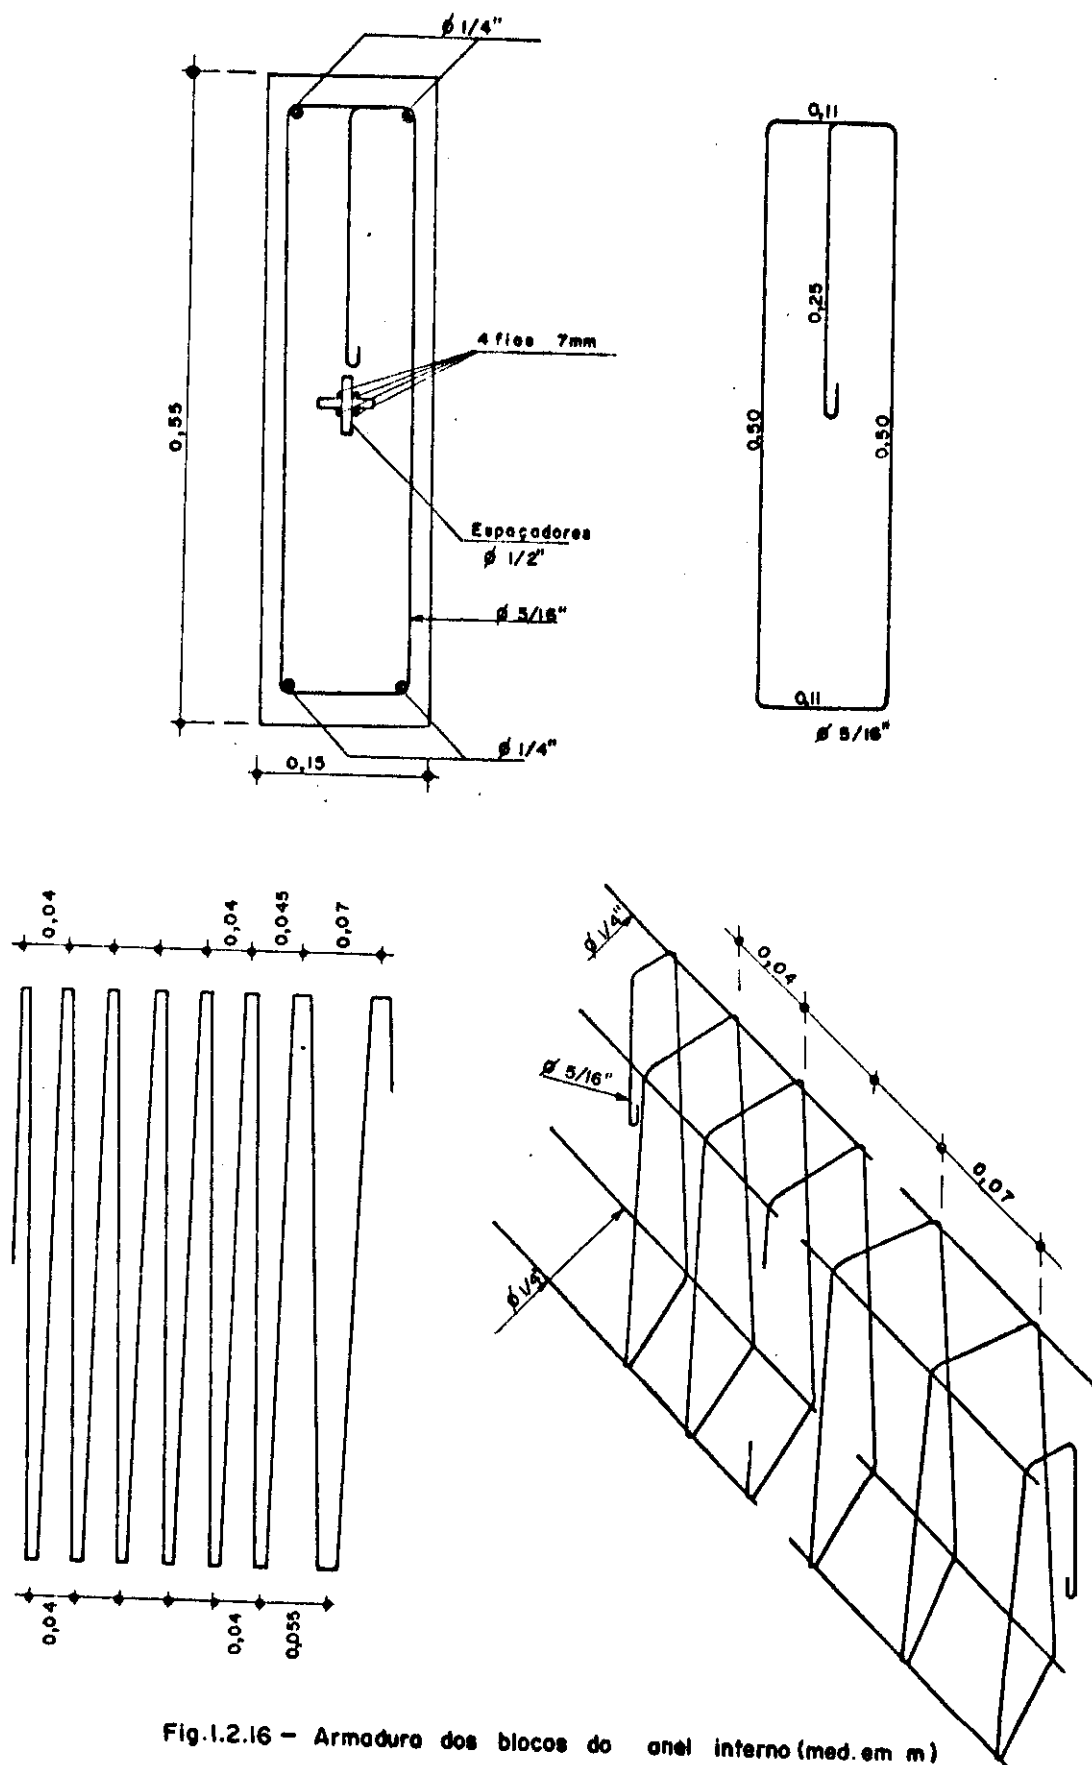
Armadura dos blocos do anel interno (med. em m)
